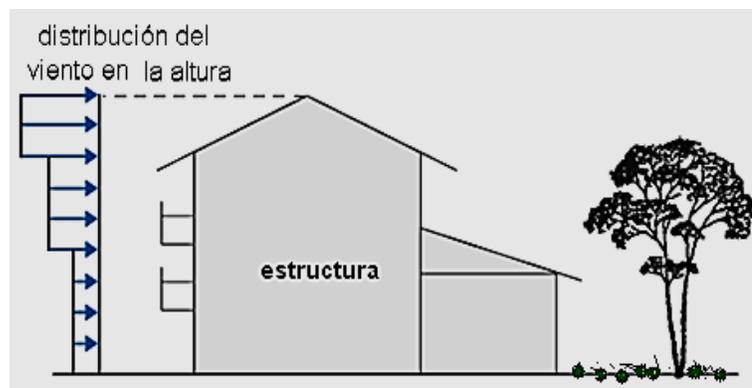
Sección transversal en que actúan las fuerzas de viento en una vivienda
